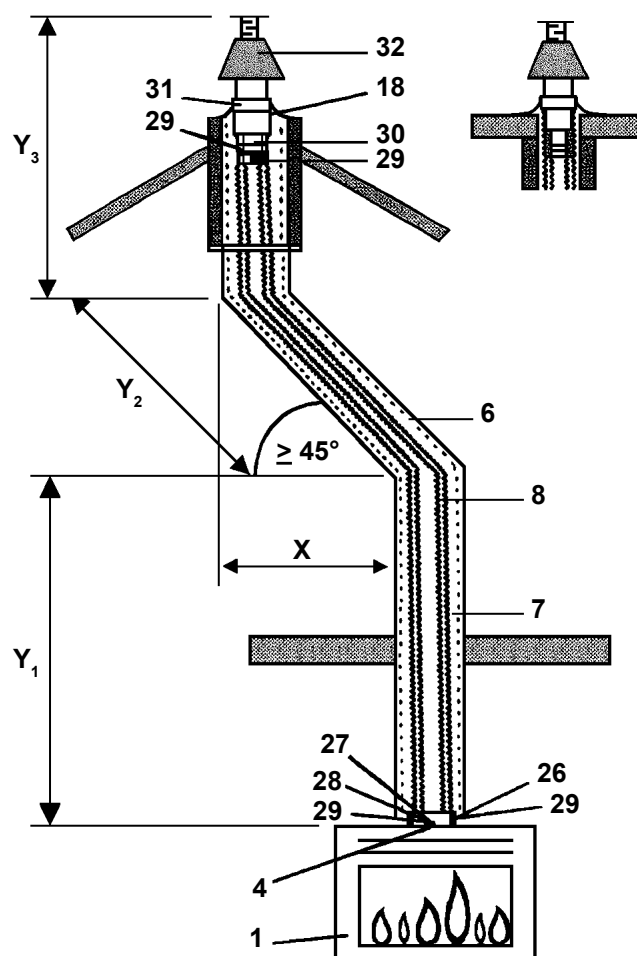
Sortie pour cheminée verticale en utilisant un conduit de fumée “fuite” existant ou si un conduit de fumée n’est pas présent
